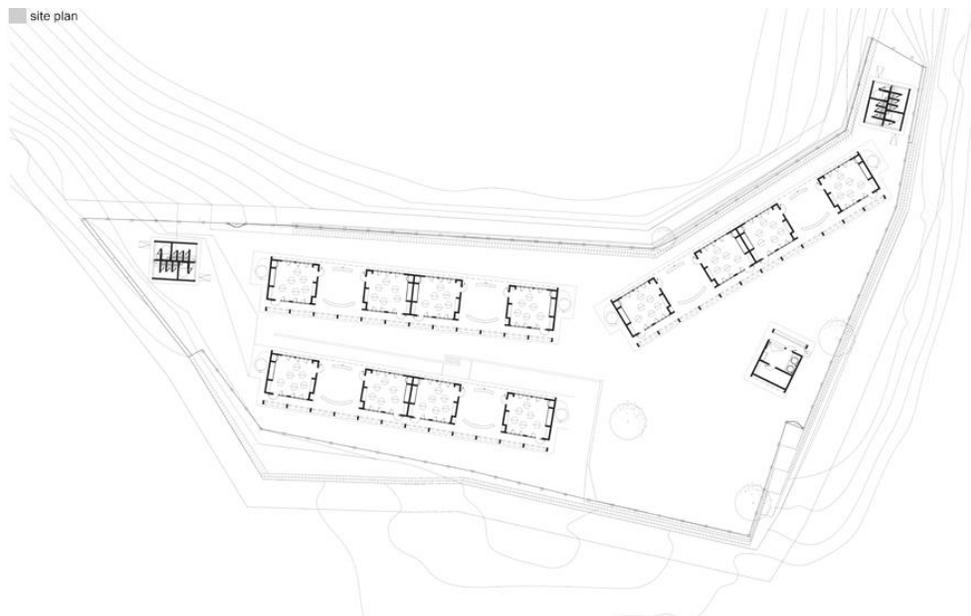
PLANIMETRIA CENTRO EDUCATIVO MUGOMBWA.
